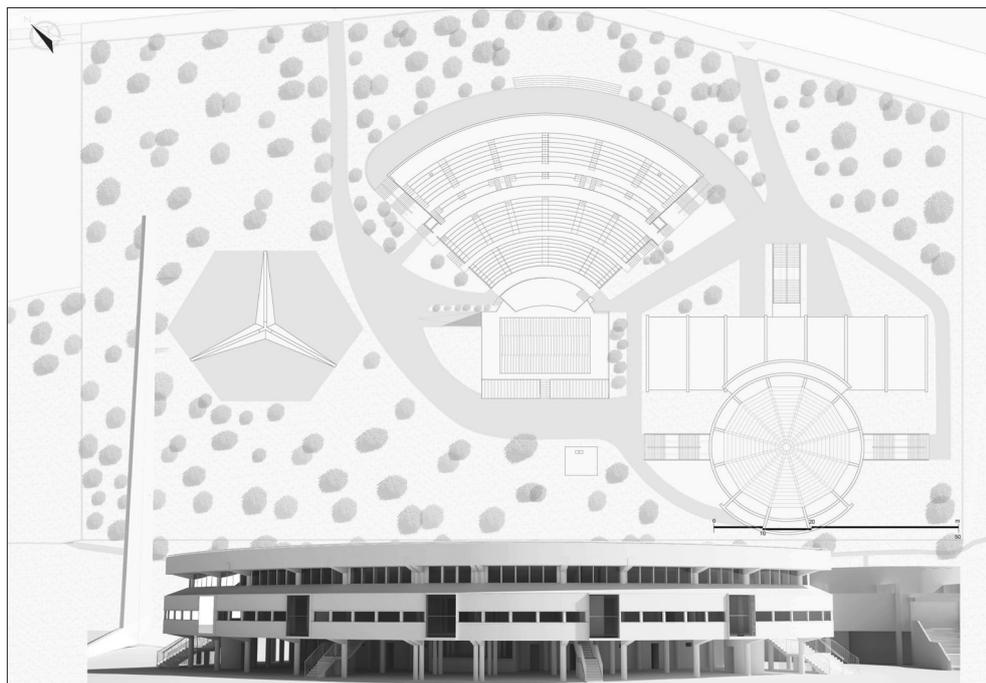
LEVANTAMIENTO DE LA PLANTA BAJA Y DE LA FACHADA PRINCIPAL. Imagen: I. Adrakta, 2014.
